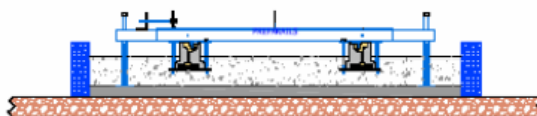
Fase 4. Colocación de armaduras y vertido del hormigón de fijación
